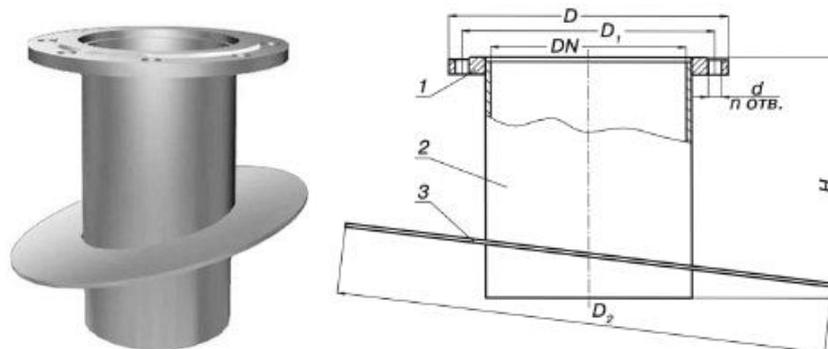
Патрубок монтажный ПМ-200. Изображение (слева) и общий вид (справа), [163]: 1 – фланец; 2 – труба; 3 – усиливающая накладка
